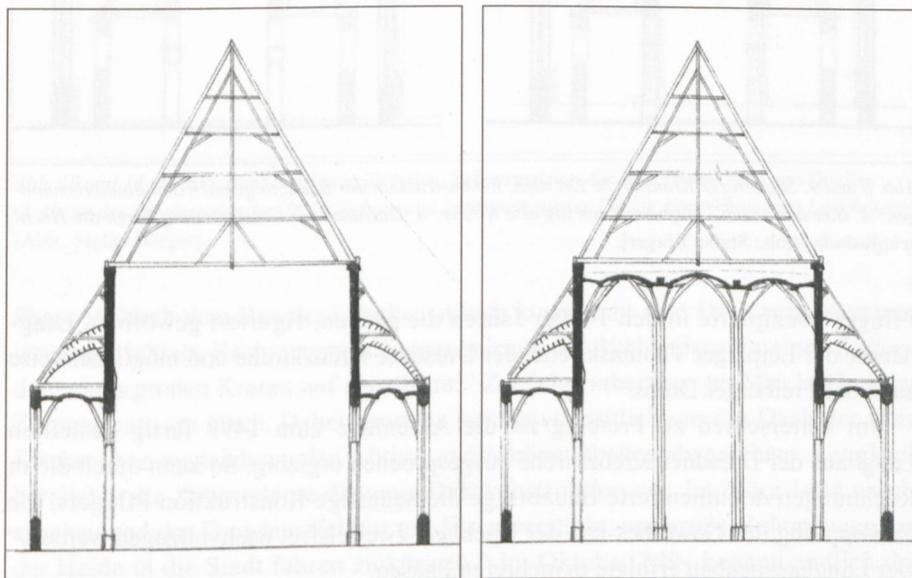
und 7: Fünfschiffige Peterskirche in Görlitz, schematische Darstellungen zum Dachbau und zur Einwölbung des Hallenlanghauses in getrennten Bauphasen: 1. Freigespannte Dachkonstruktion über den drei mittleren Schiffen; 2. Errichtung der Freipfeiler mitsamt der Wölbung [Abb.: Stefan Bürger].
